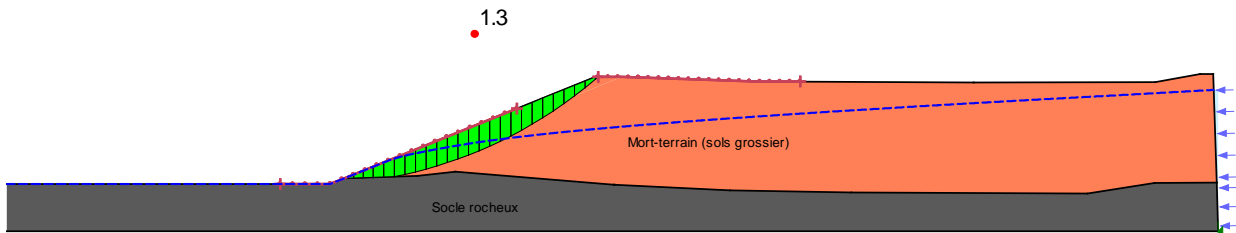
Stabilité court terme, excavation dans des sols grossiers
